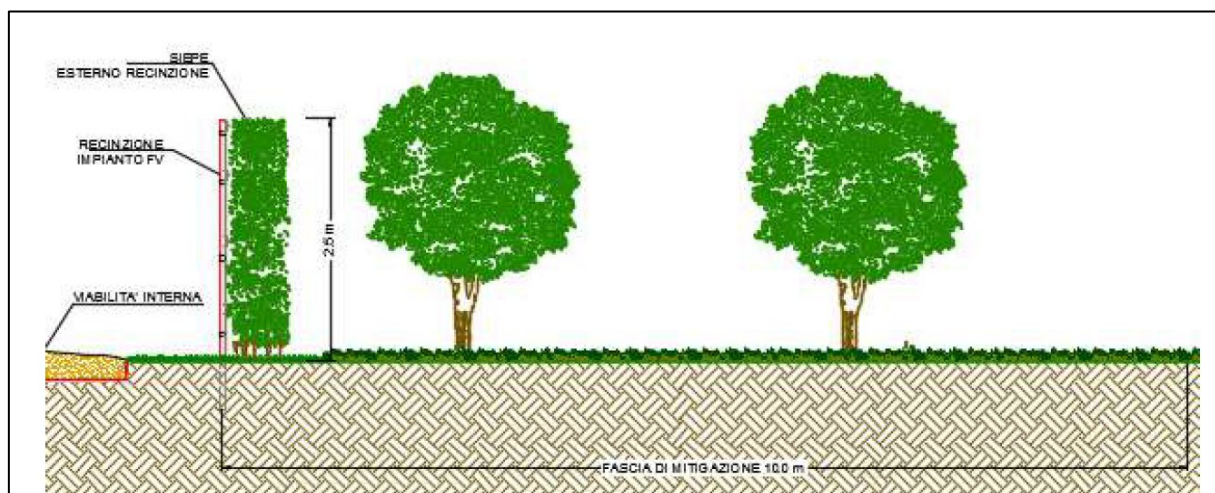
Layout fascia di mitigazione perimetrale- Sezione
